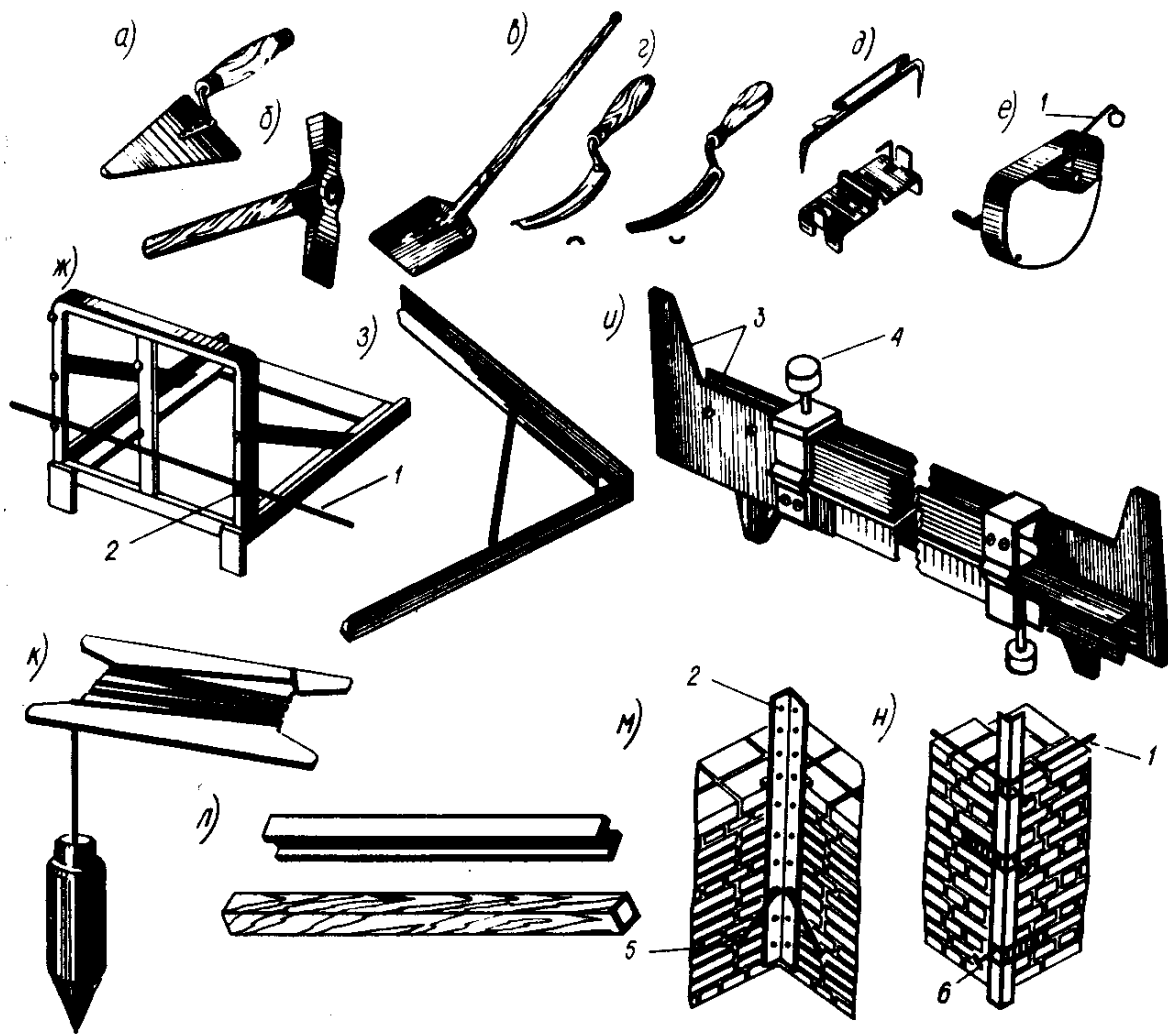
Виробничий ручний інструмент і пристрої:
